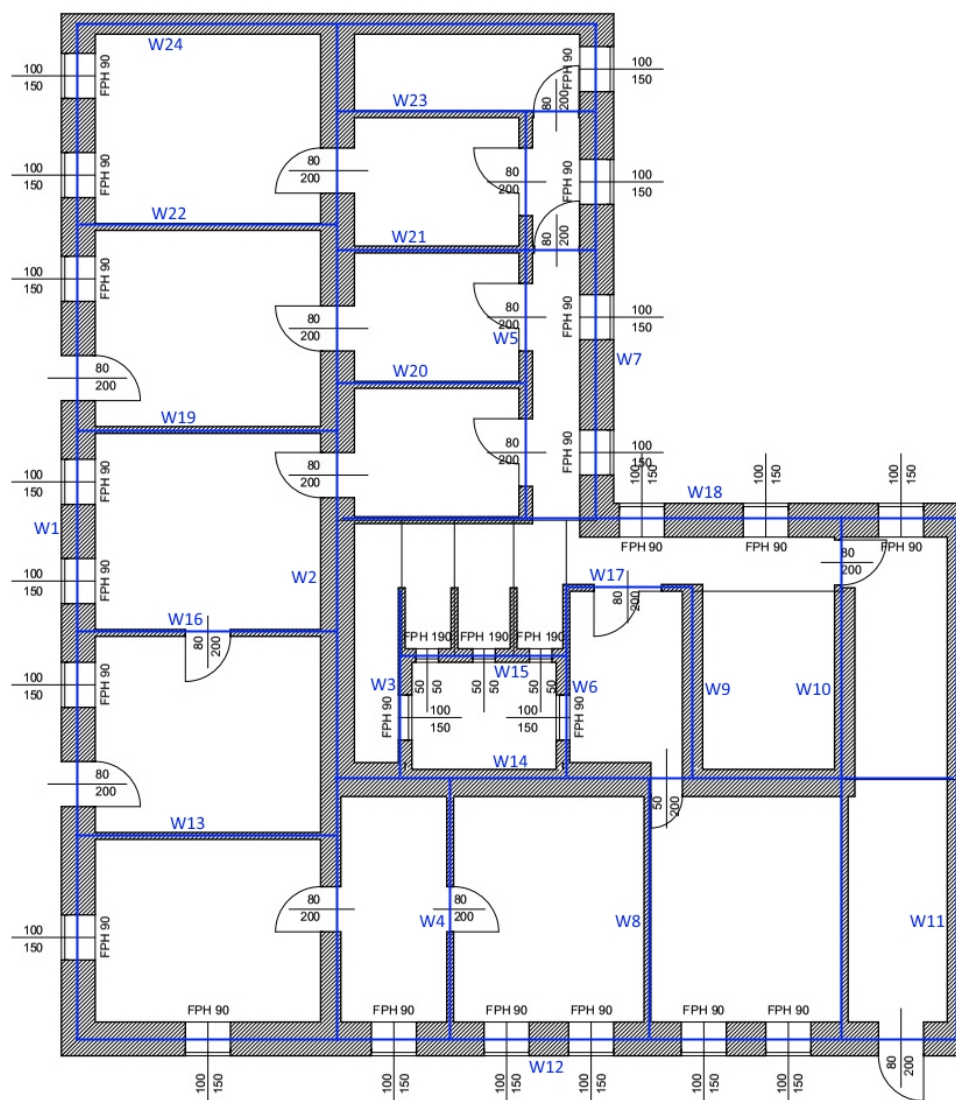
Nummerierung der Wände des symmetrischen Grundrisses
